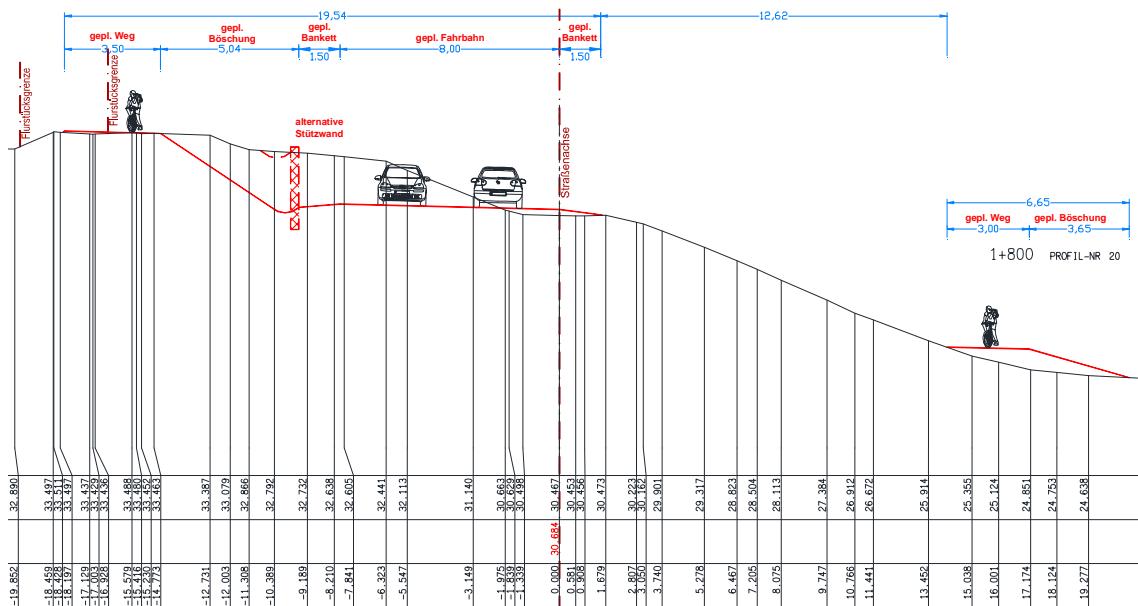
Abschnitt 5, Vorzugsvariante Trasse T1
